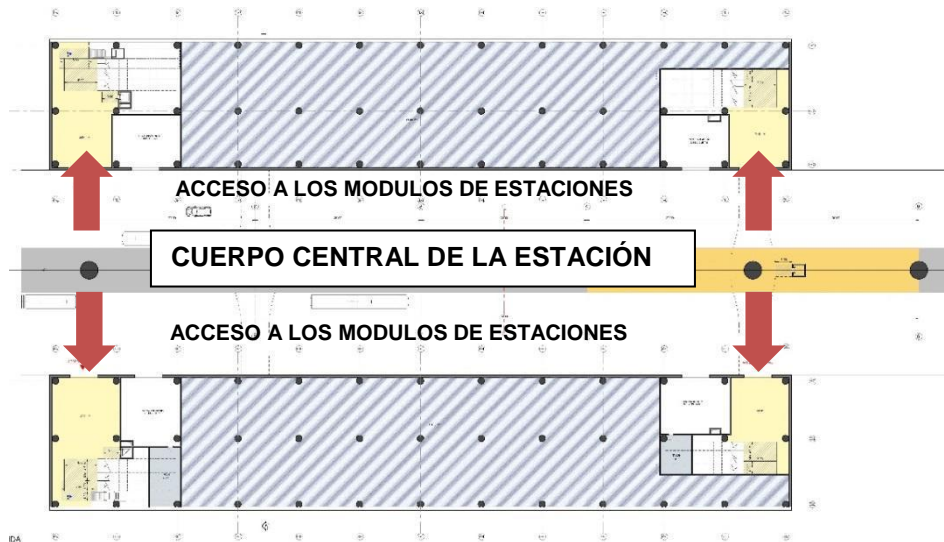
Planta baja de una estación interconexión. Fuente: Elaboración propia
